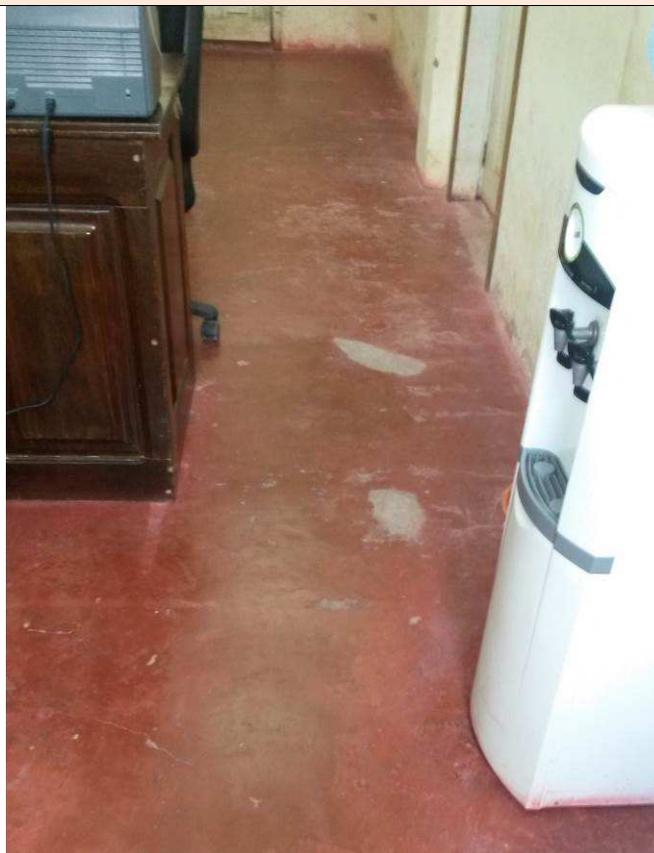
Piso da secretaria encontra-se bastante desgastado.
